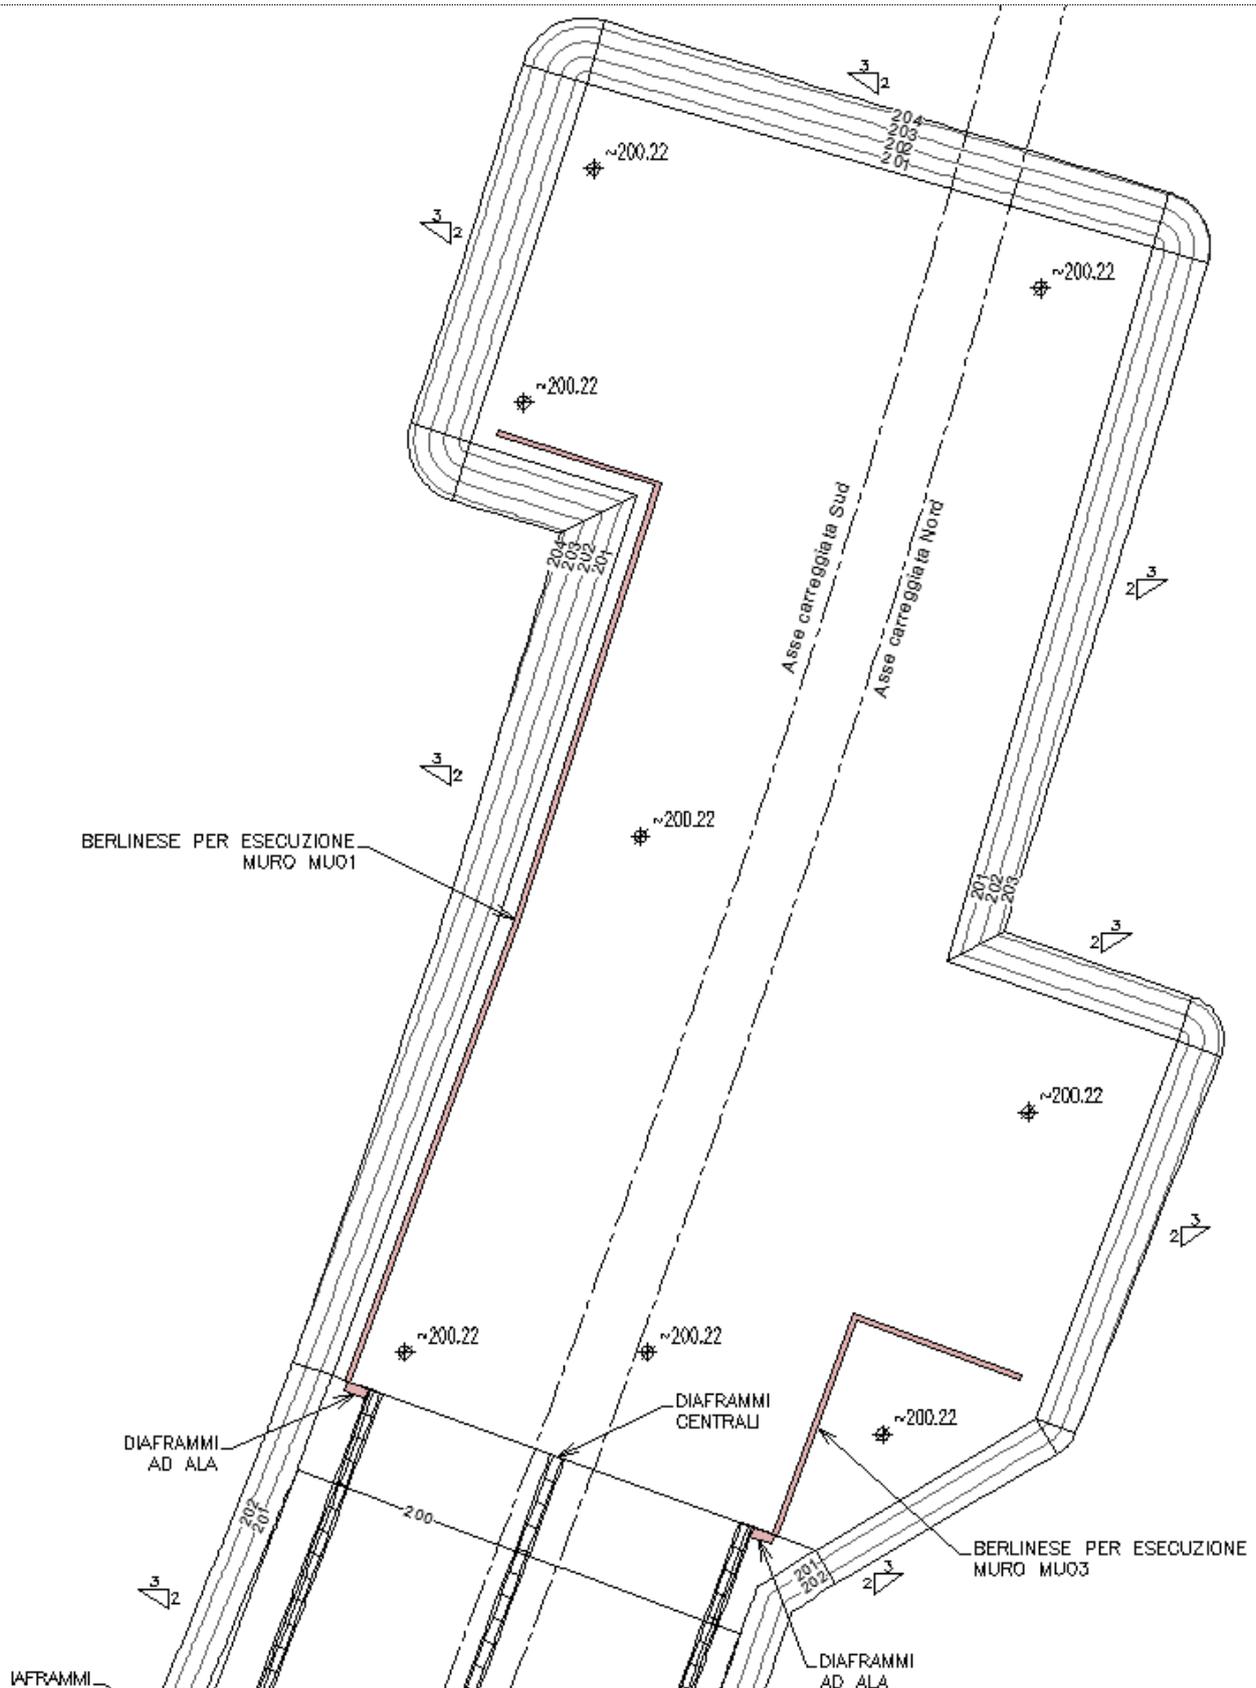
Planimetria berlinese/diaframmi ad ala - Nord
